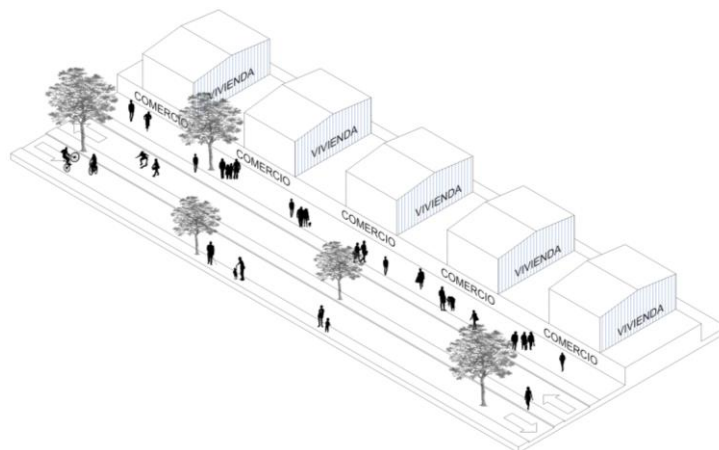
En la colectora, planta baja comercio, planta alta vivienda. Un barrio activo. Elaboración grupal Taller Avanzado
